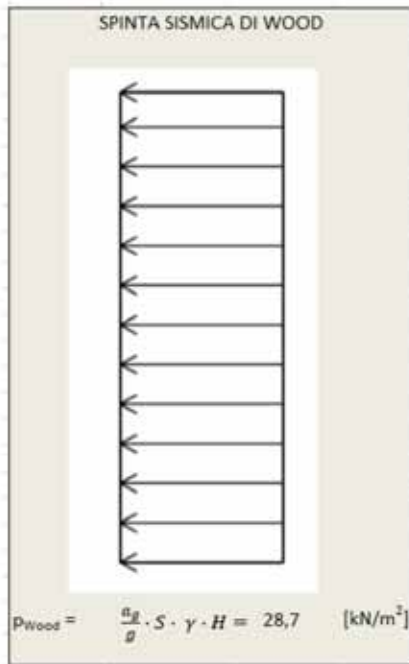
SPALLA A – Spinta sismica Wood
